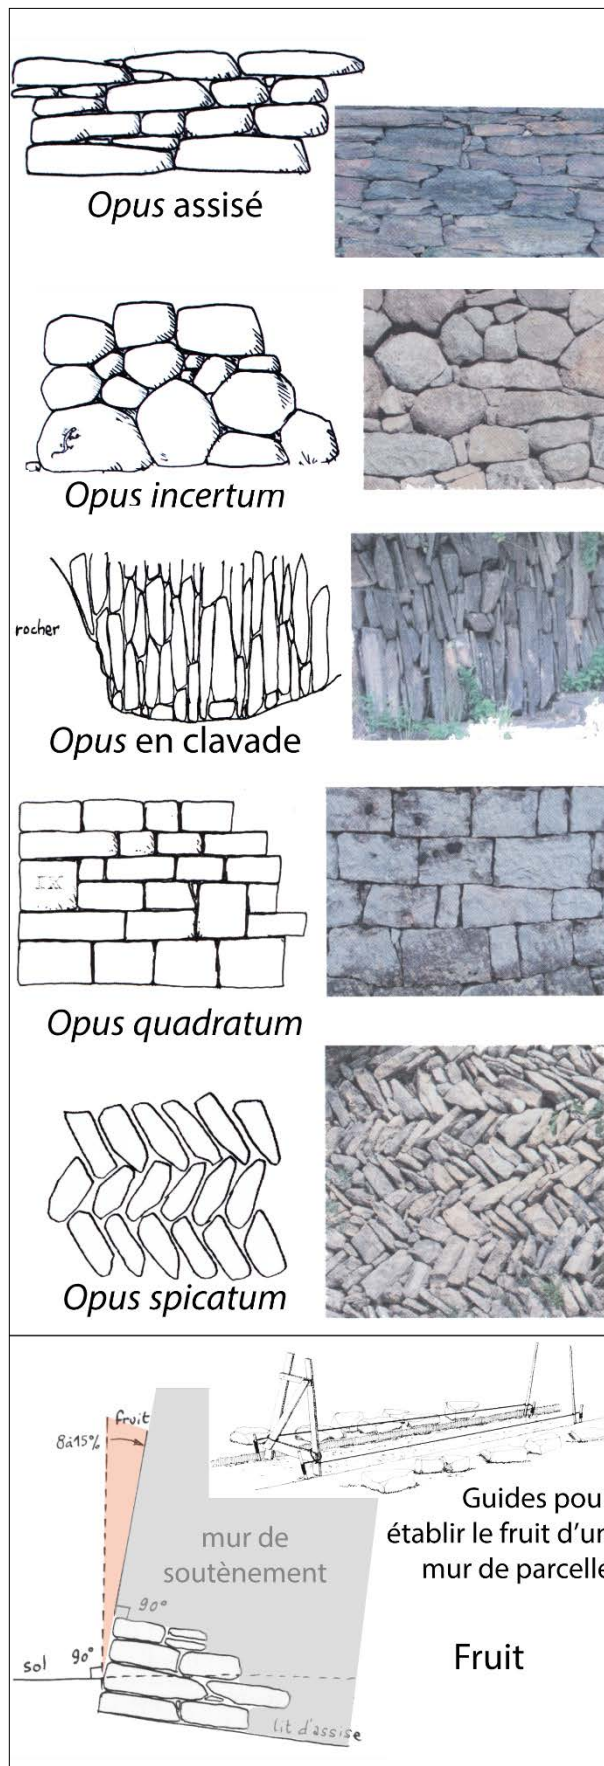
Appareils de la maçonnerie en pierre sèche et définition d'un fruit (dessins et photos CAPEB 2008).
